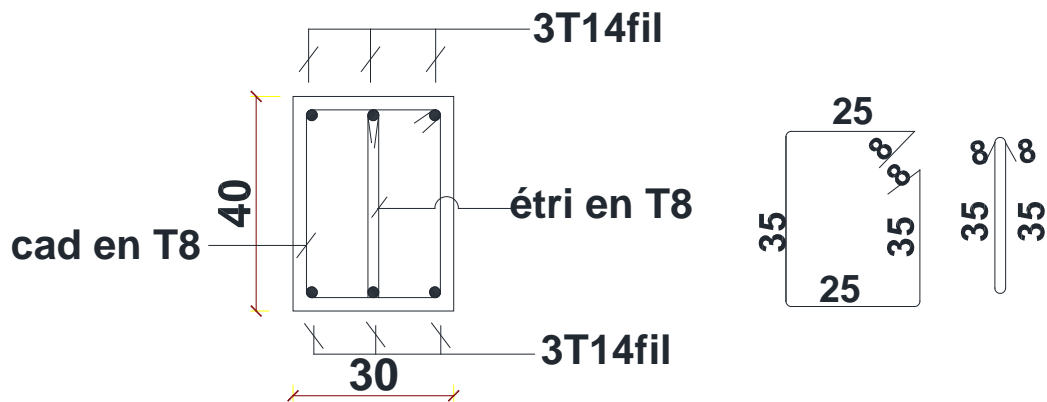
Schéma de ferrailage des poutres secondaire.
